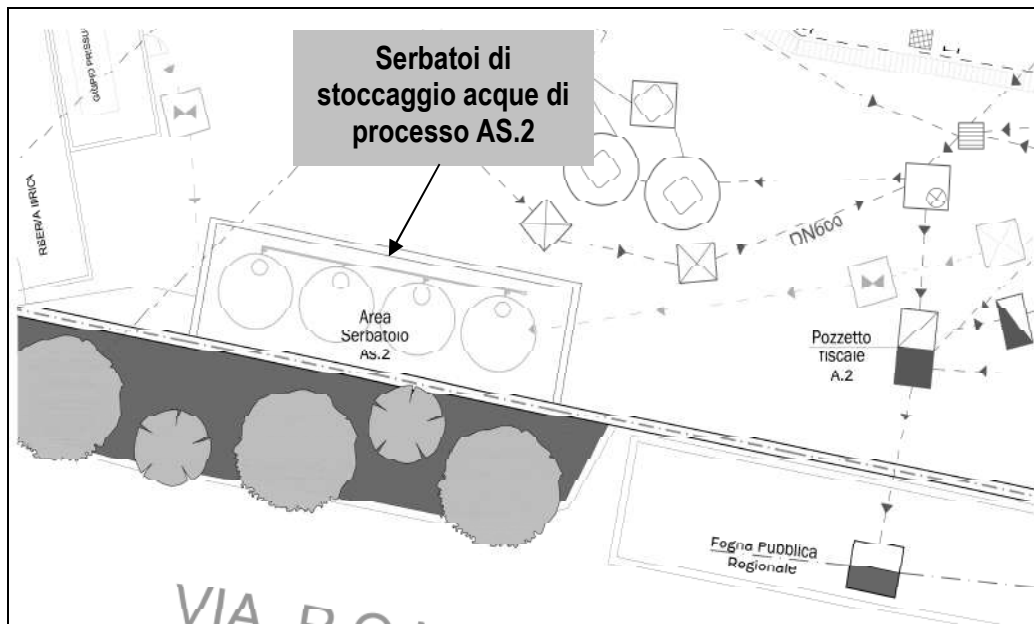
Stralcio planimetrico con indicazione dei serbatoi di stoccaggio acque reflue di stabilimento
